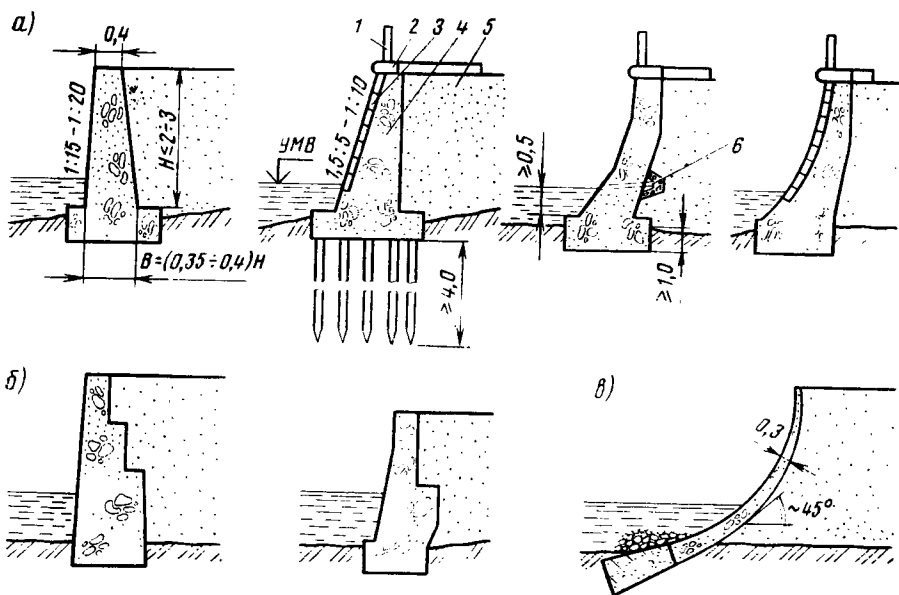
Поперечные сечения массивных подпорных стен городских набережных:
